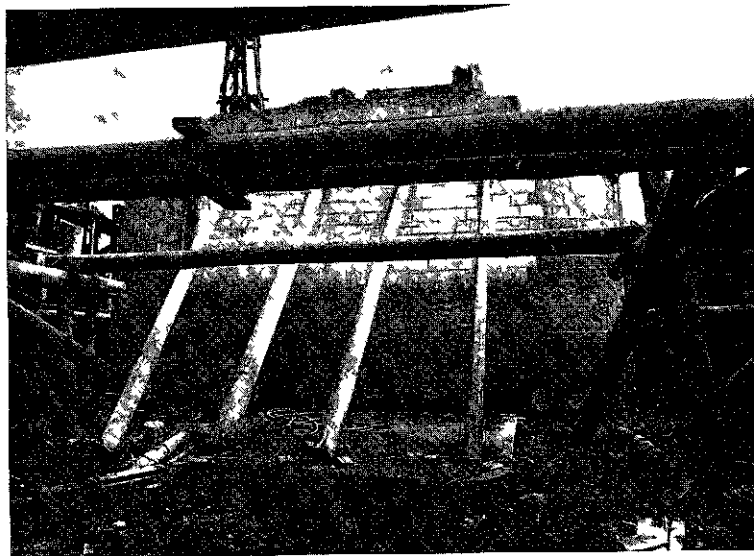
Face côte travee centrale apres confection des quatre elements des poutres en beton arme et installation des verins qui serviront aux operations de redressement
